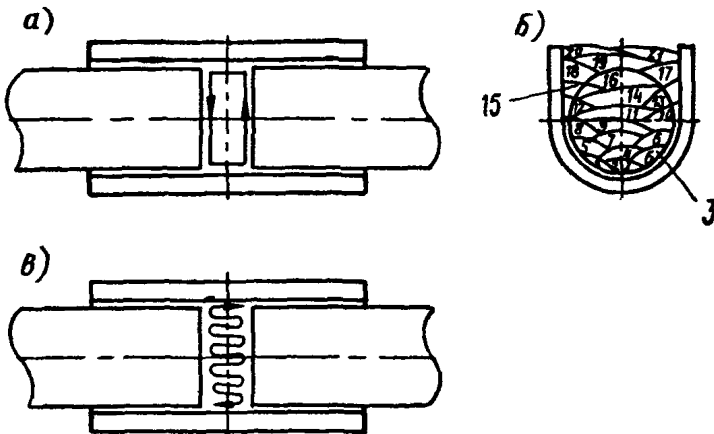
Техника полуавтоматической дуговой сварки стыкового соединения горизонтальных стержней многослойными швами
